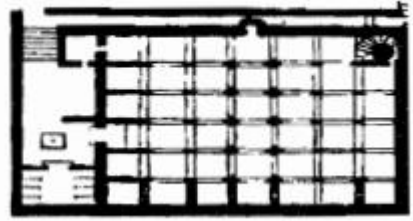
مسقط أفقي لجامع سوق الغزال لقسنطينة عن/
